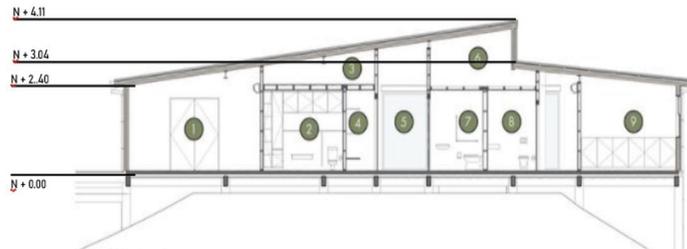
Planta y Zonificación de la escuela New Shoots ECEC
